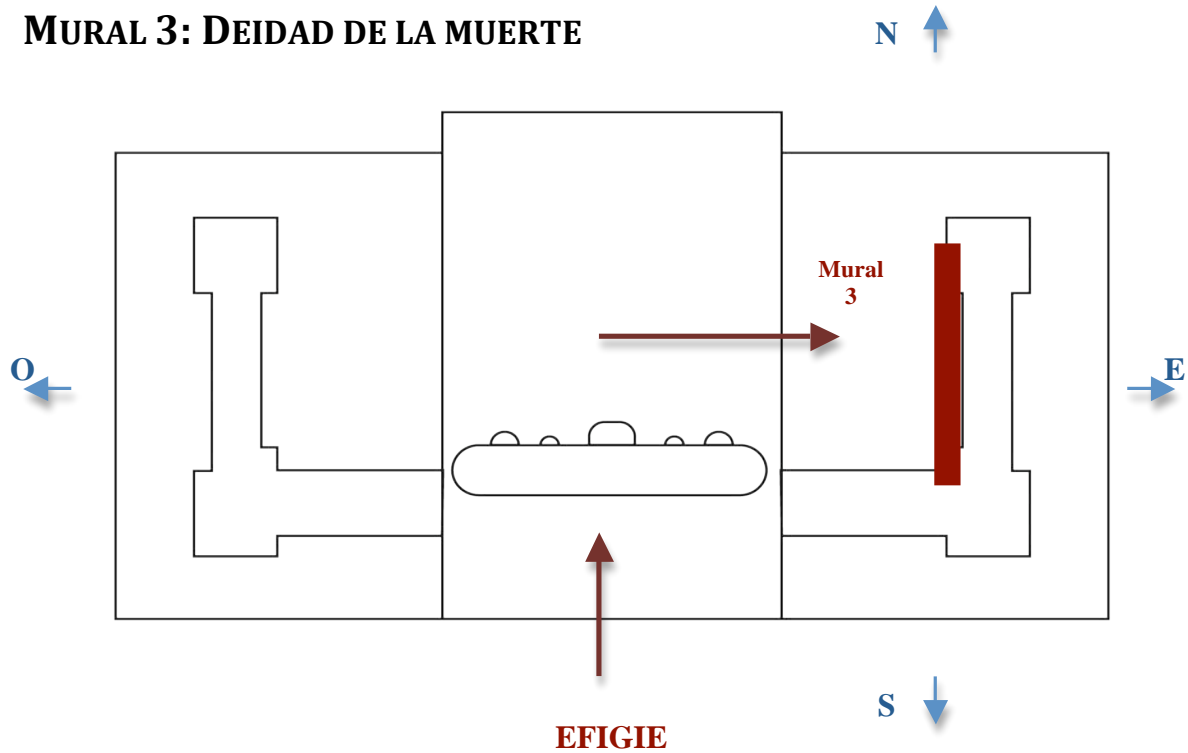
Mural 3: Deidad de la muerte. Planta del adoratorio.
